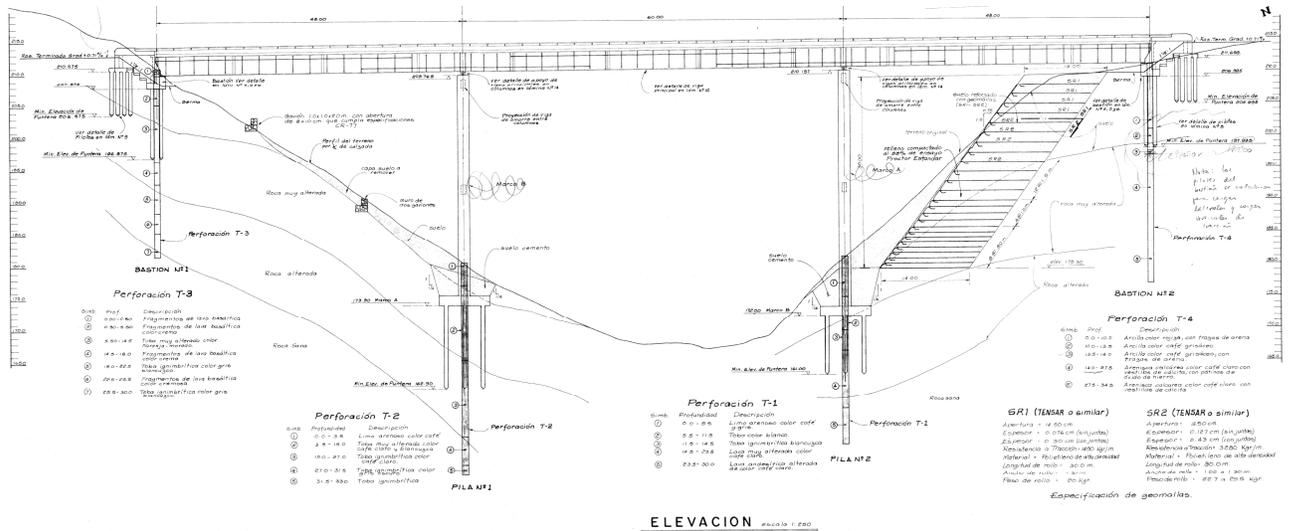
Vista en elevación norte del puente incluida en los planos estructurales.
